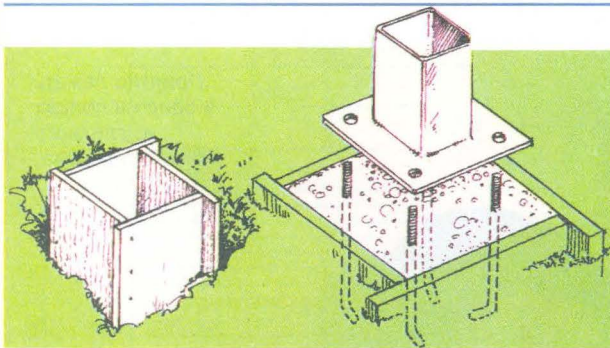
Опалубка под бетонный столбик сделана из четырех досок, в качестве анкеров забетонированы отрезки арматуры с резьбой на концах.
